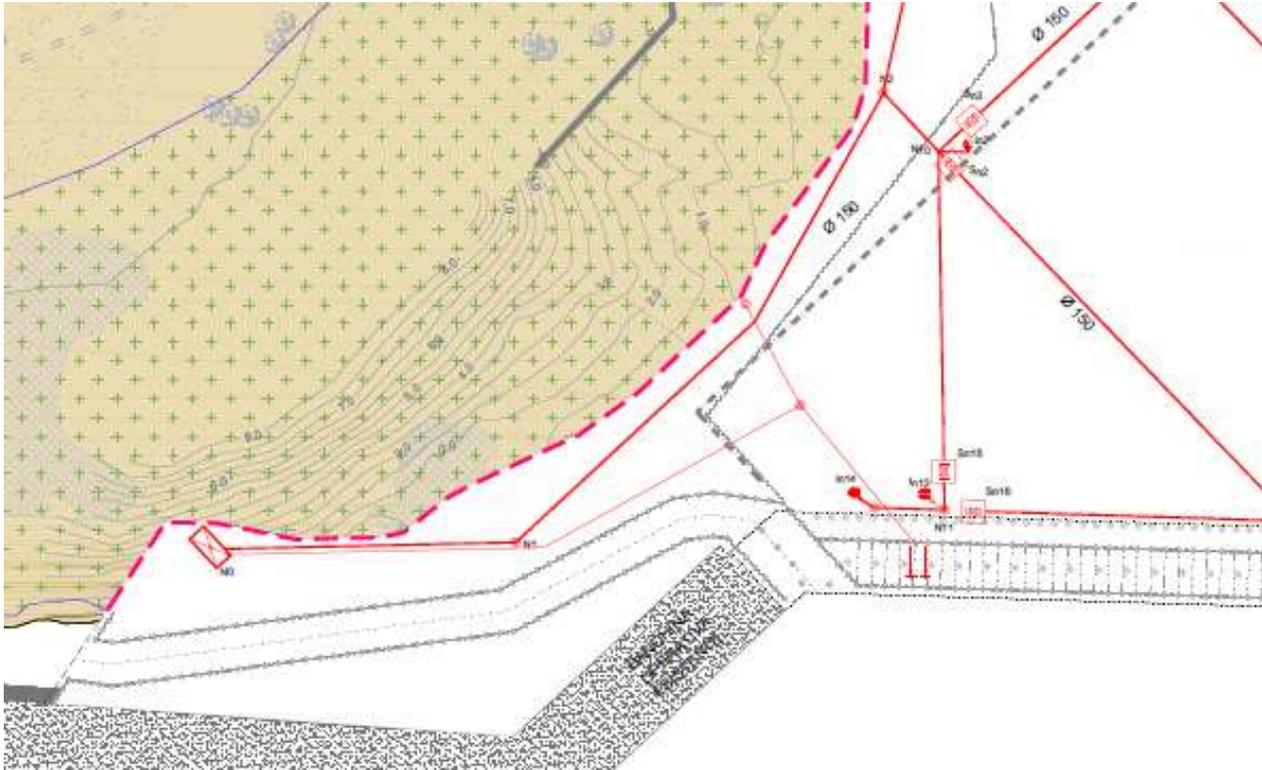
Planimetria rete antincendio Perizia di Variante – Particolare oggetto di modifica
